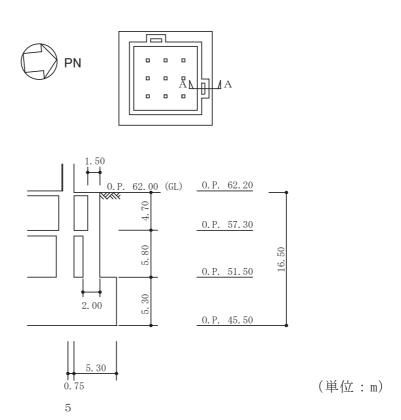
(1) 緊急時対策建屋の概略断面図 (A-A 断面, NS 方向)
